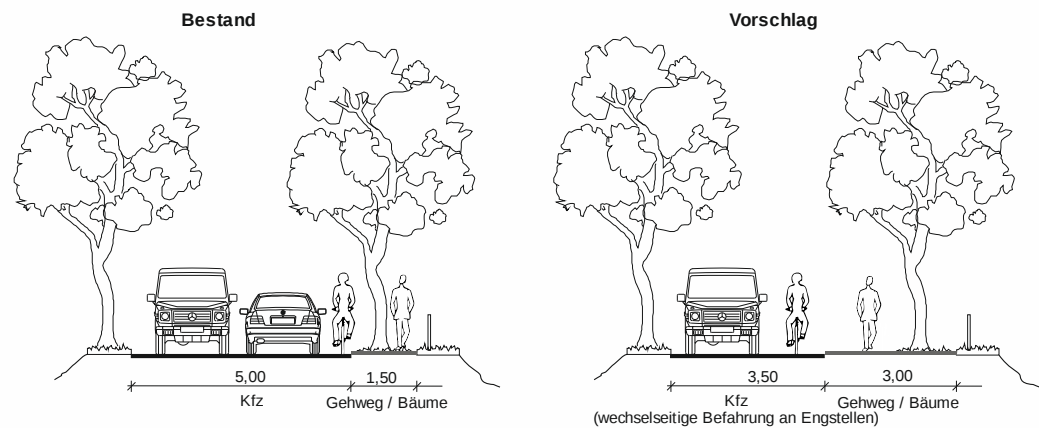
Hubstraße nördlich Waldshuter Straße - Bestand und Planungsvorschlag
